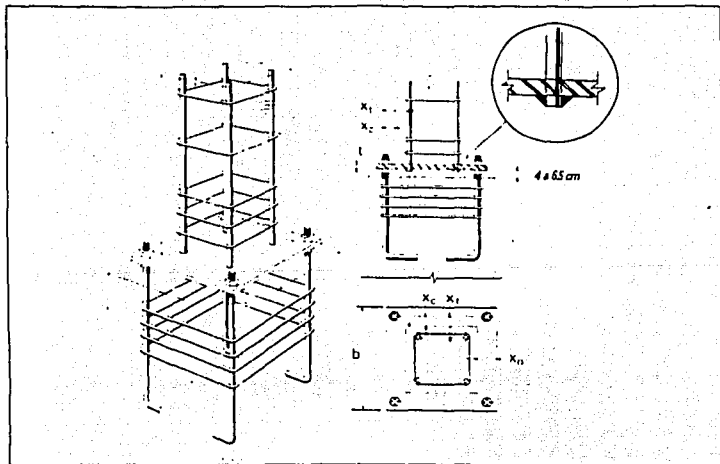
PLACAS DE BASE DE COLUMNA MAYORES QUE LA SECCION TRANSVERSAL DE LA COLUMNA.
